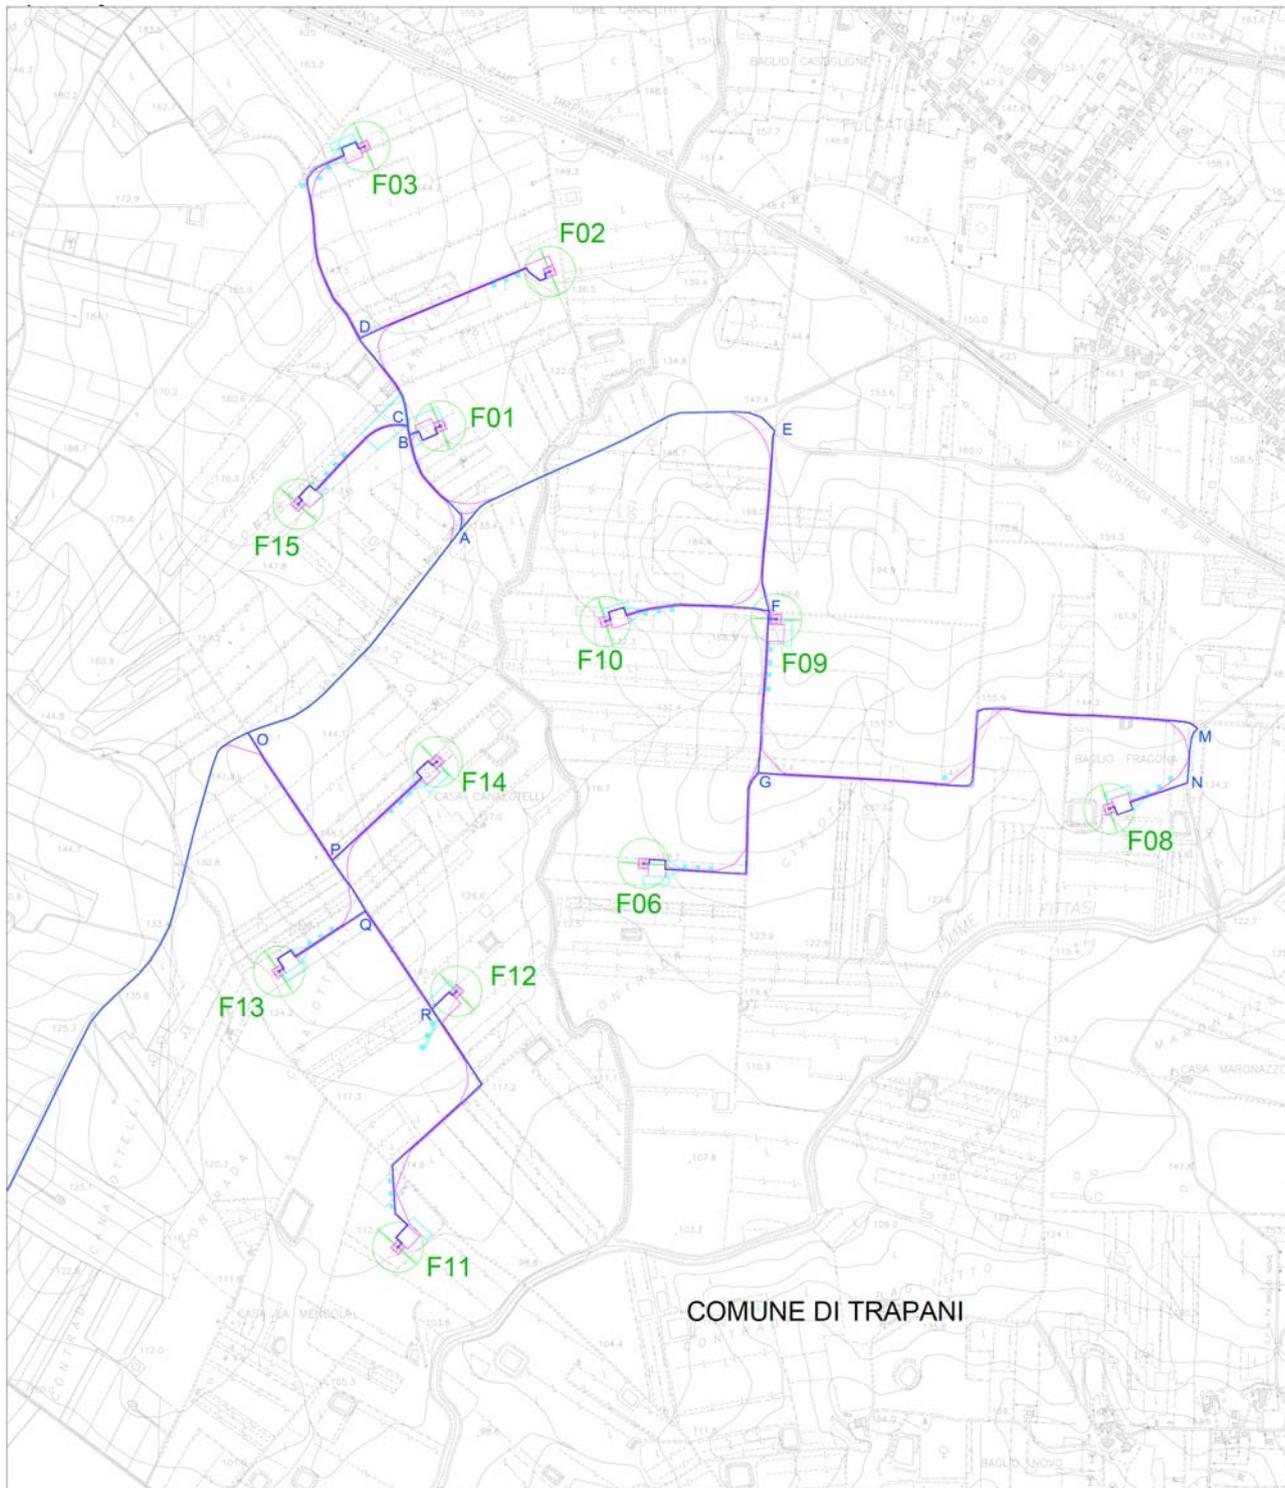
Stralcio CTR col layout del progetto rimodulato con 12 WTG
